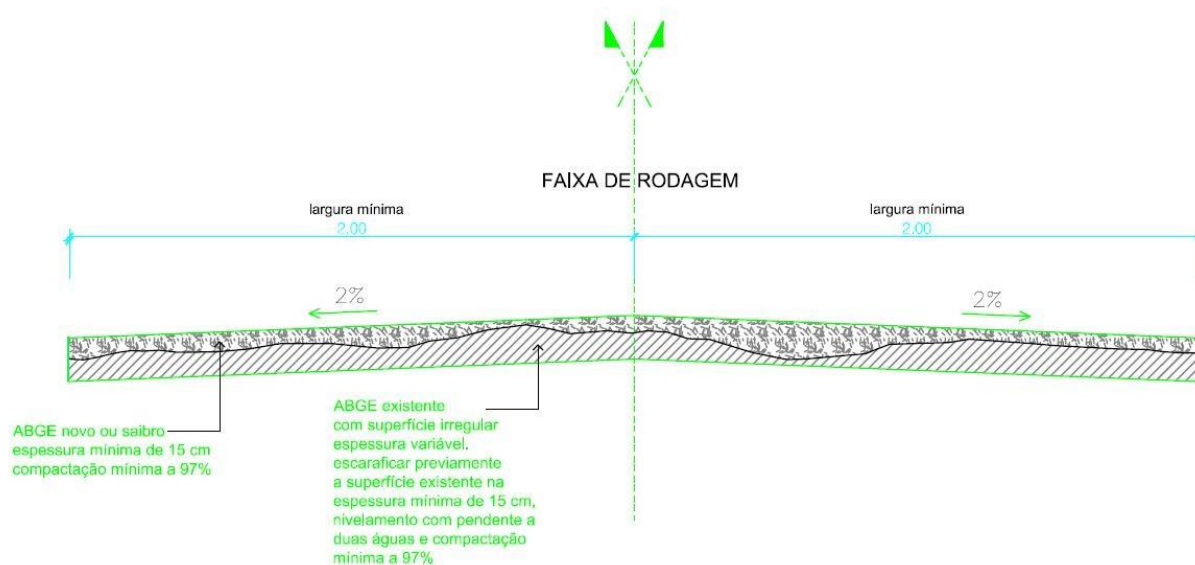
Corte de pavimento tipo reabilitado com ABGE simples³²
